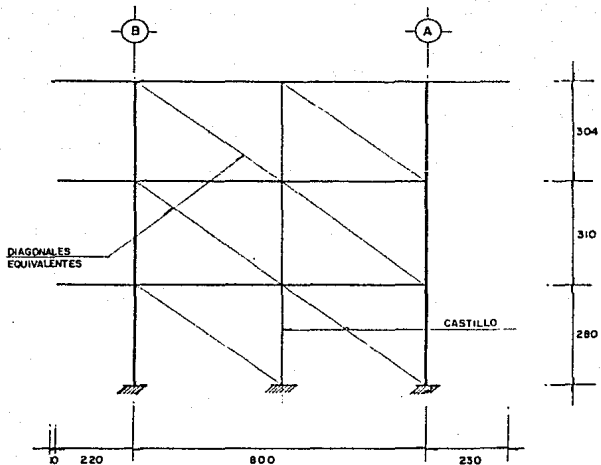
MARCO TRANSVERSAL CON MURO DE TABIQUE CONFINADO.
